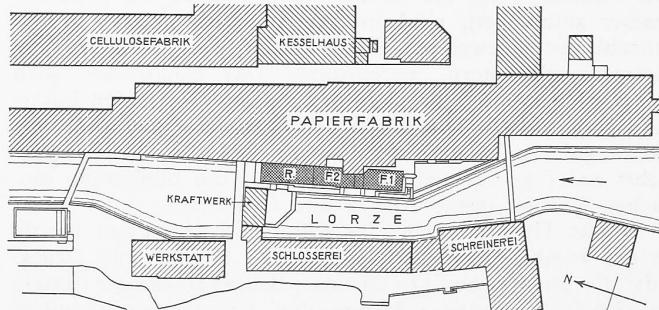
Lageplan der Schnellfilter-Anlage der Papierfabrik Cham, 1 : 2000.
